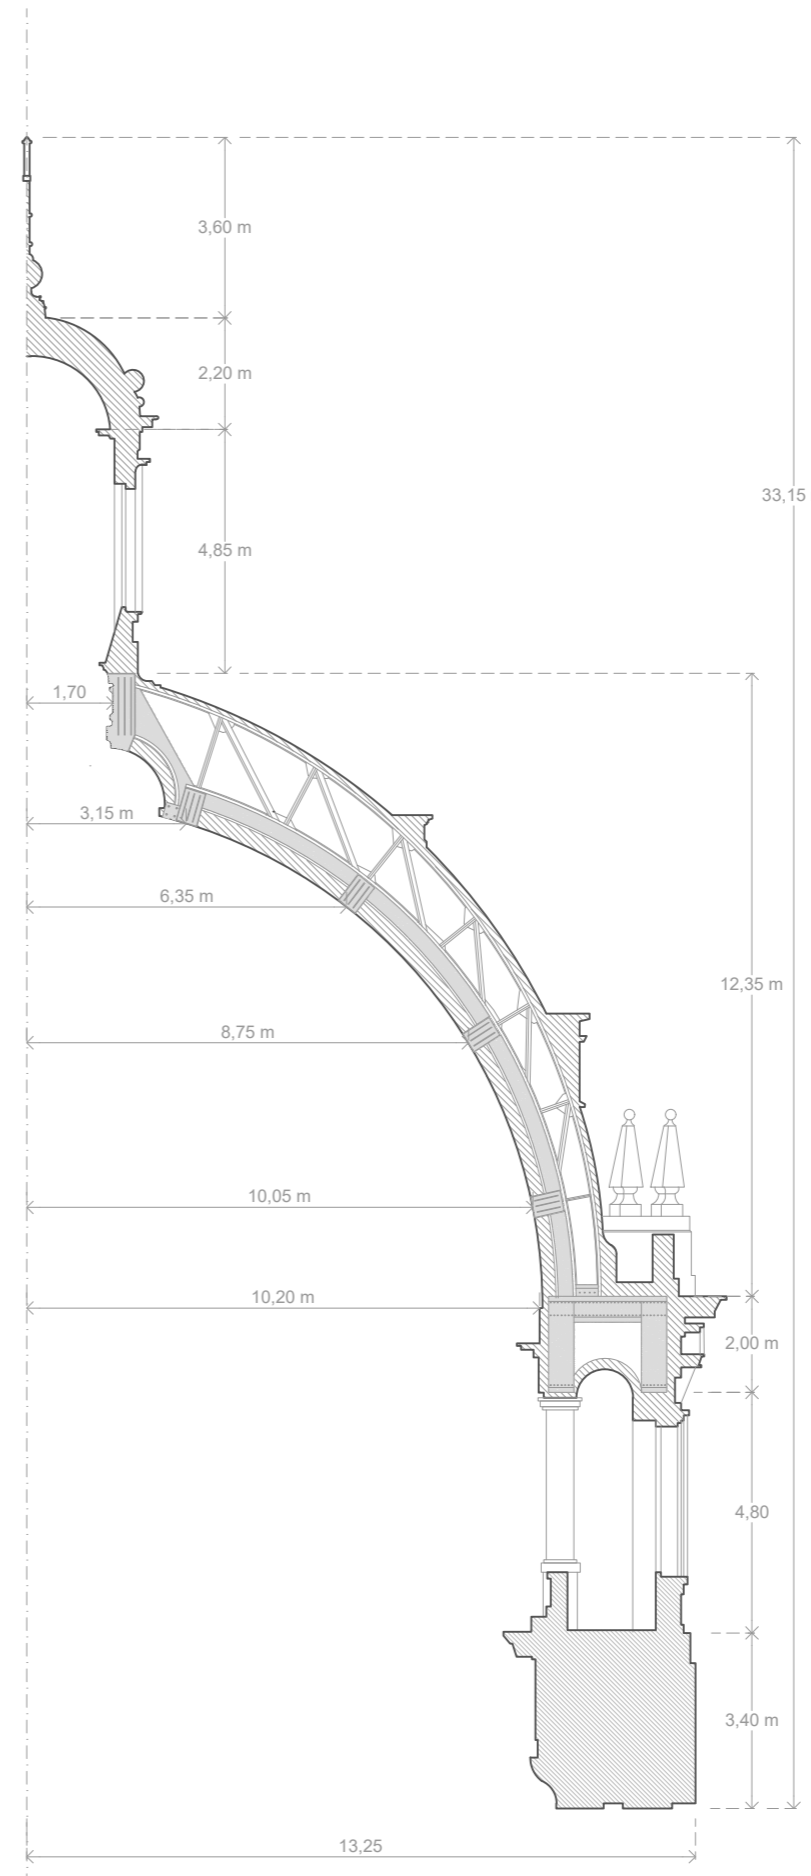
Plano de despiece de la estructura. Elaboración propia.
